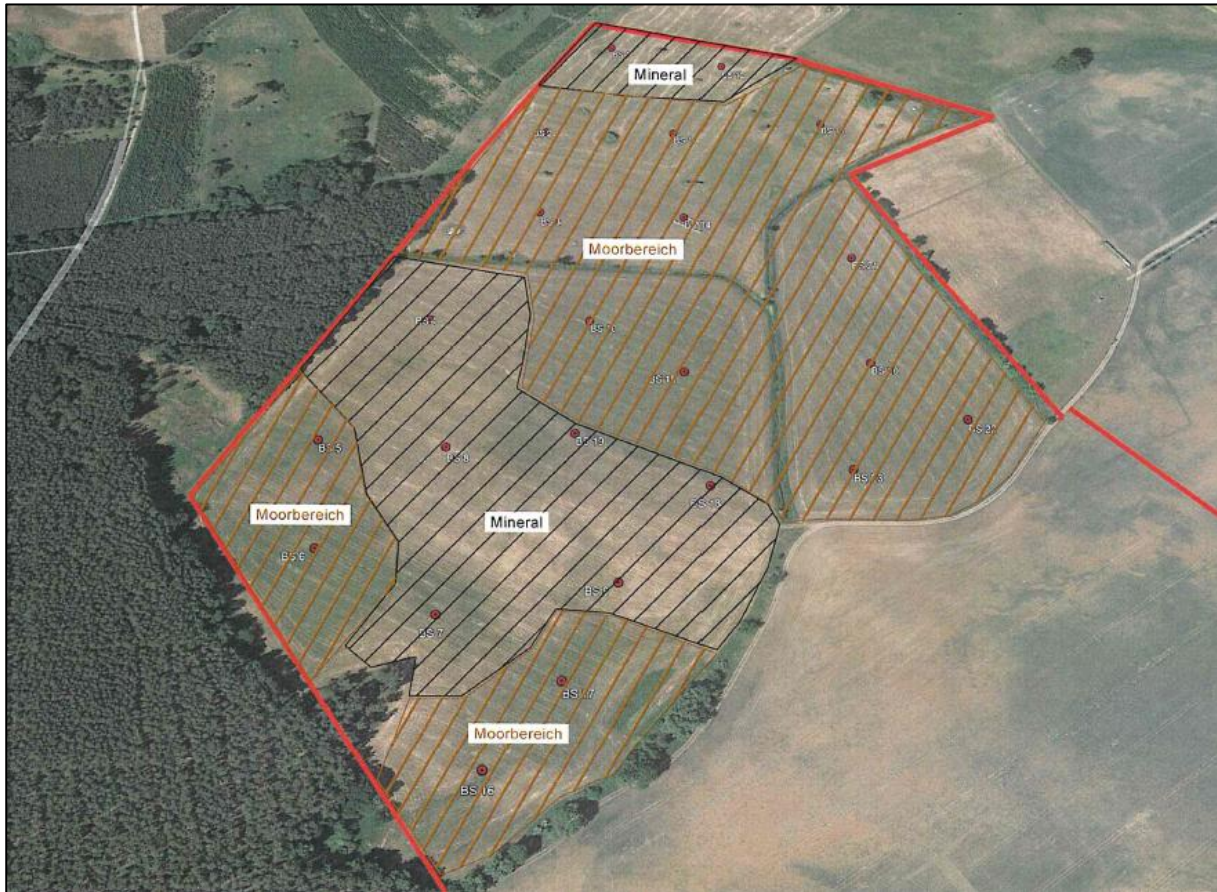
Lageplan Baugrunduntersuchung, Geotechnischer Bericht
